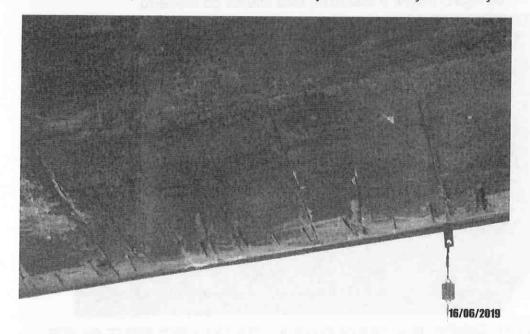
Detalhe de armadura exposta na face inferior da extremidade do tabuleiro.
